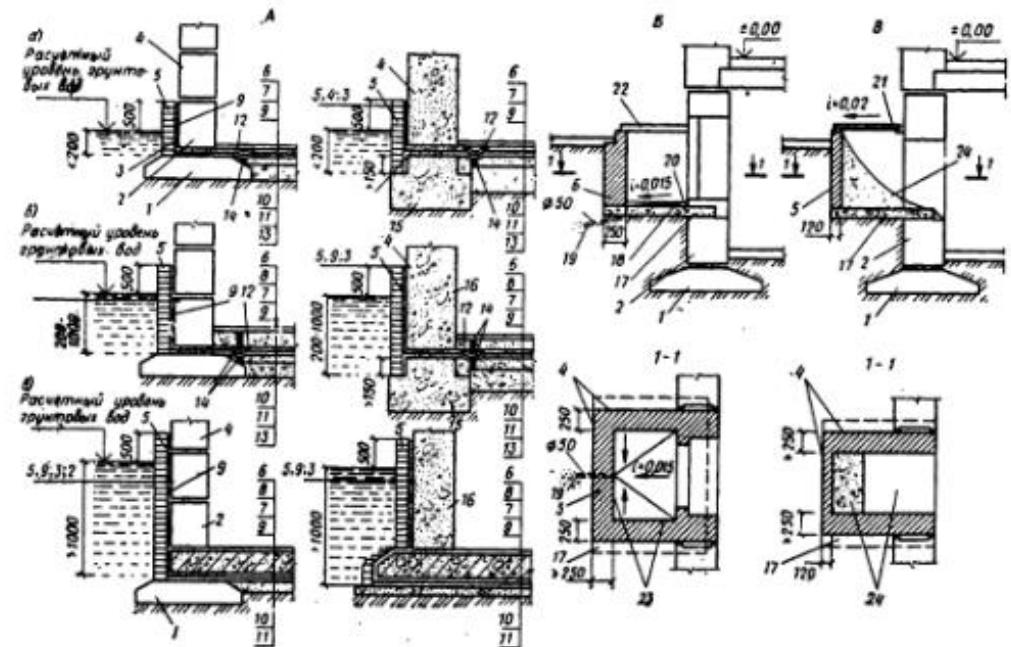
Гидроизоляция фундаментов, устройство примокв и люков в стенах подвалов: А - гидроизоляция фундаментов и подвалов; а - при уровне грунтовых вод до 200 мм; б - то же, более 200-1000 мм; в - то же, более 1000 мм; Б - световой приямок; В - загрузочный люк; 1 - фундаментная плита; 2 - бетонные блоки стен подвала; 3 - выравнивающая затирка цементным раствором; 4 - окраска горячим битумом за два раза до отмостки; 5 - стенка из полнотелого красного кирпича на цементном растворе толщиной 120 мм на всю высоту оклеечной гидроизоляции; 6 - пол подвала; 7 - защитная стяжка из цементного раствора 30 мм; 8 - железобетонная плита (пригрузочная); 9 - оклеечная гидроизоляция; 10 - выравнивающая стяжка из цементного раствора 20 мм; 11 - бетонная подготовка - 100 мм; 12 - стеклоткань; 13 - жирная глина 200-300 мм; 14 - заполнение битумом деформационного шва; 15 - монолитная бетонная или бутобетонная фундаментная подушка; 16 - бетонная или бутобетонная монолитная стена подвала; 17 - железобетонная плита; 18 - цементная стяжка с железением; 19 - крупный щебень или галька; 20 - затирка цементным раствором; 21 - металлическая решетка; 22 - крышка люка; 23 - цементная штукатурка; 24 - бетон с затиркой поверхности цементным раствором
